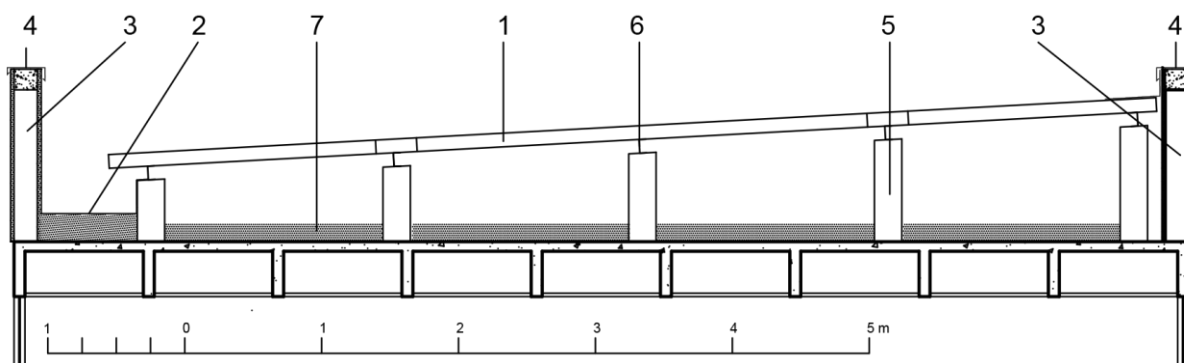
Planta de cobertura e o projeto do telhado sobre laje dos Blocos K e L da Administração Central (Fonte: SEF)
